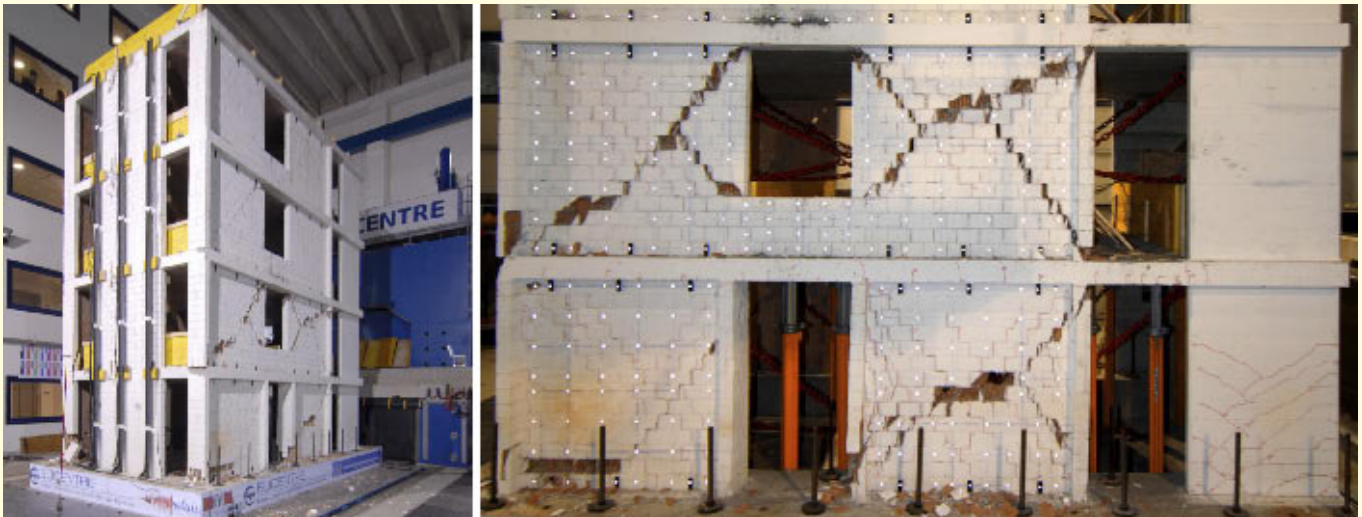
Rütteltischversuch an einem viergeschossigen Gebäude im Maßstab 1:2 mit Mauerwerks- und Stahlbetontragwänden (links), Detail der unteren zwei Geschosse, die in Längsrichtung angeregt wurden (rechts) [9].
